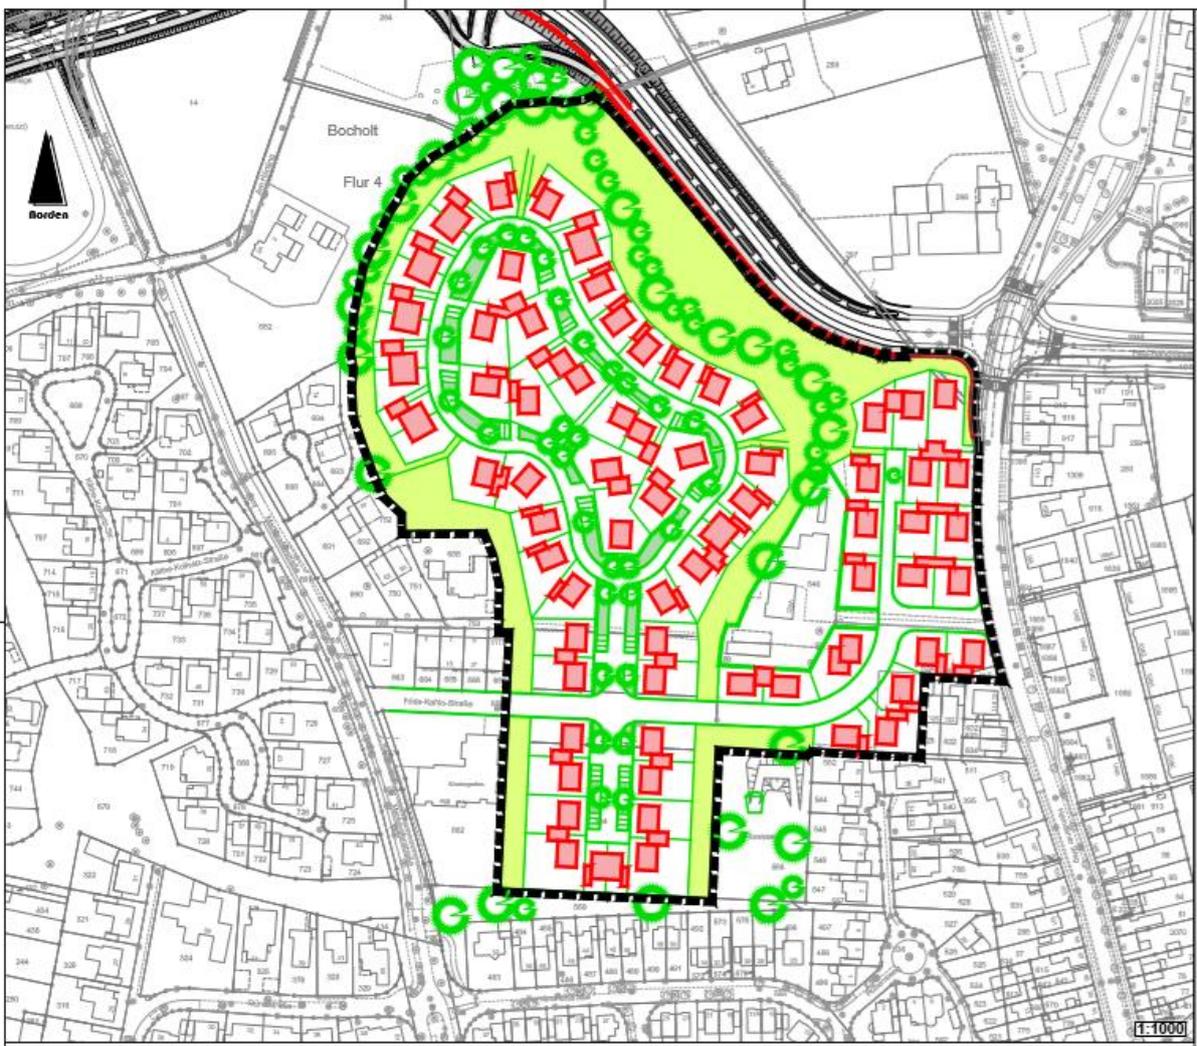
Bebauungsplanentwurf zum Bebauungsplan NW 23
